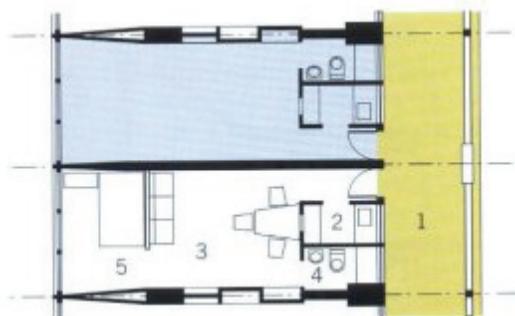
planta conjunta Pedregulho - RJ – apartamento 1 dormitório. Figura 4 fotografia conjunto Pedregulho - RJ – apartamento duplex com dois dormitórios (vista da escada do pavimento superior), projetado por Affonso Eduardo Reidy em 1947.
